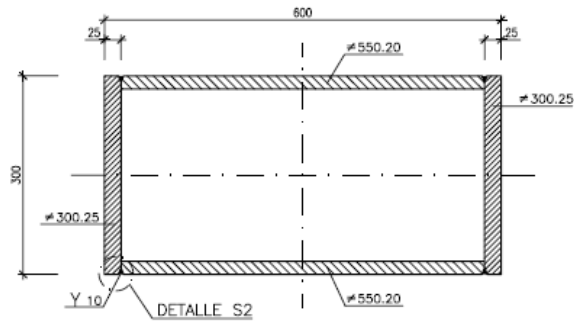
Detalle del perfil de la viga cajón de la fachada.
